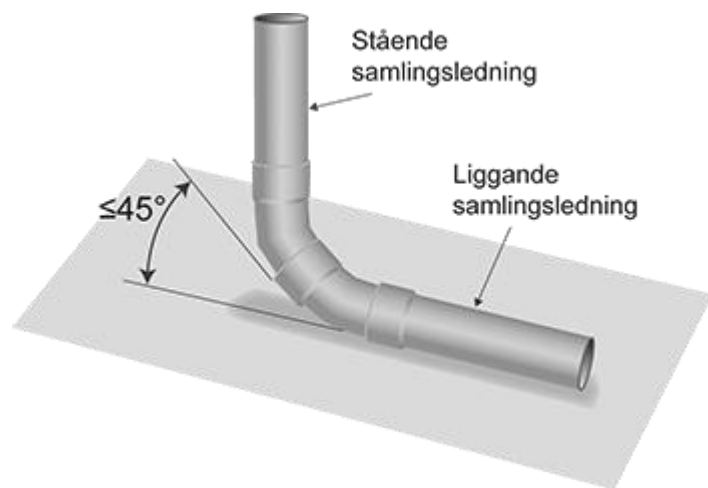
Rekommenderade vinklar mellan spillvattenledningar i en byggnad.
